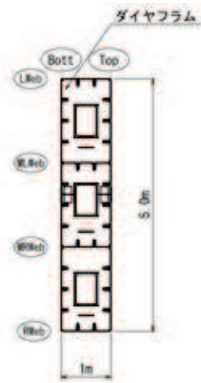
(2) 鋼製遮水壁 (鋼桁 3) 平面図
